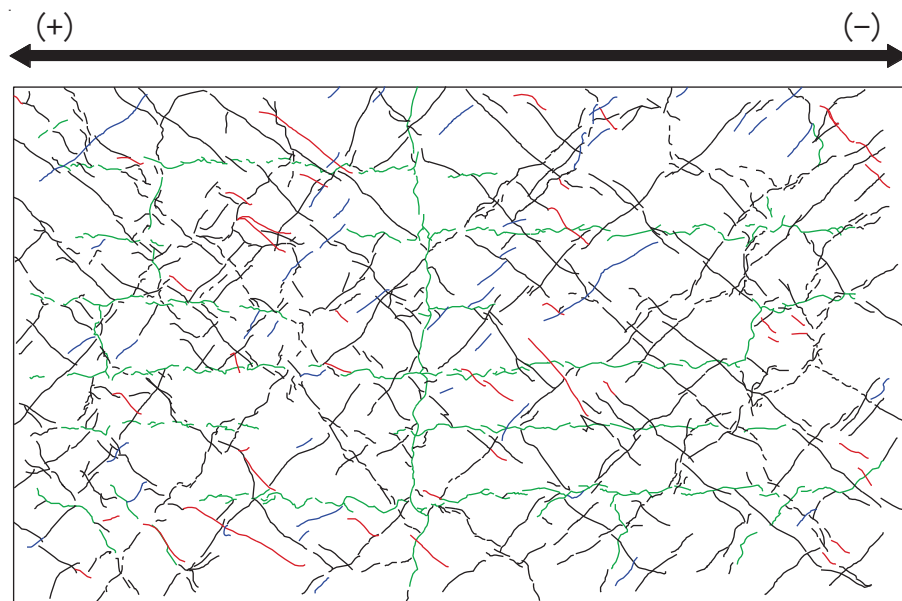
乾燥試験体 [1] 最終破壊時ひび割れ図
